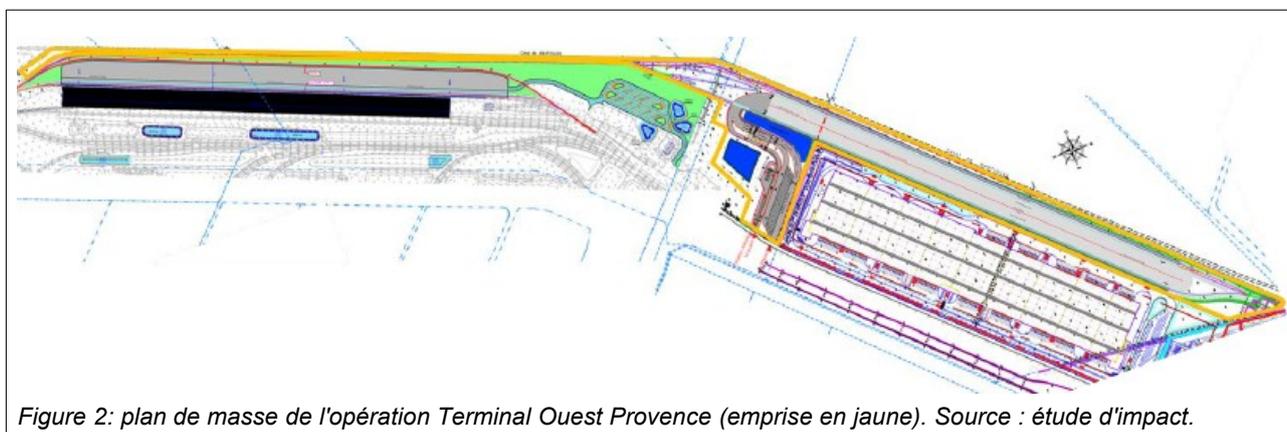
plan de masse de l'opération Terminal Ouest Provence (emprise en jaune). Source : étude d'impact.
